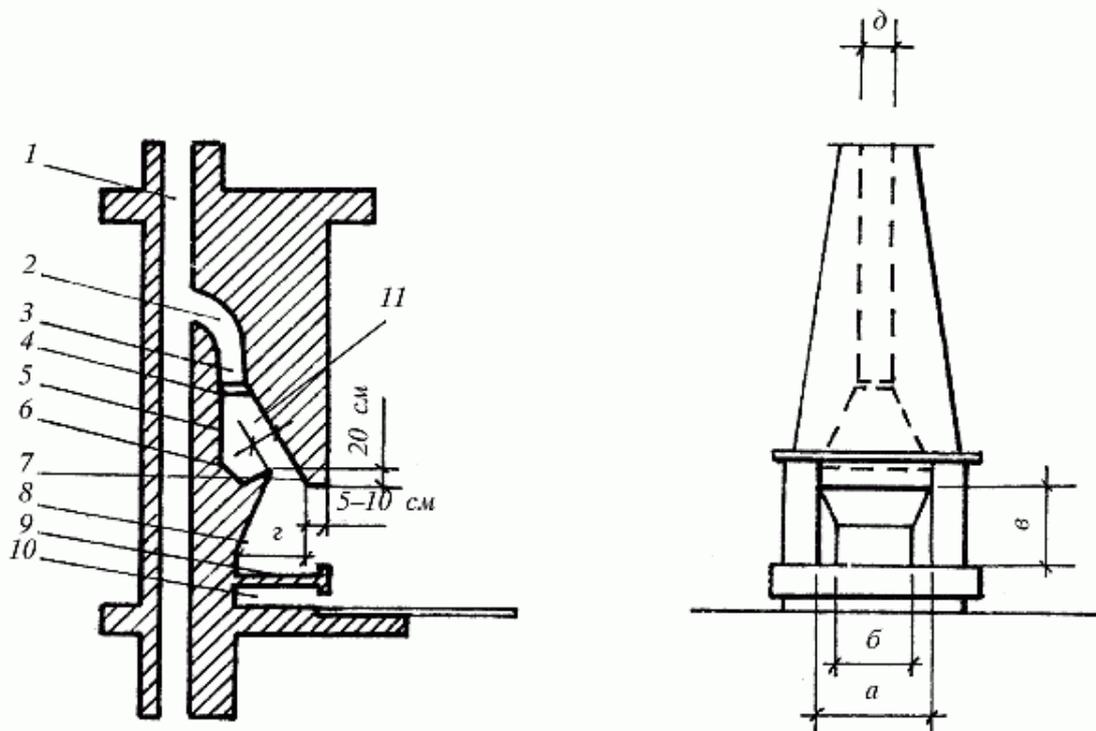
Камин, пристроенный к дымовой трубе: 1 – дымовая труба; 2 – колено; 3 – дымоход; 4 – задвижка; 5 – дымовая камера; 6 – обратное днище; 7 – стенка; 8 – топка; 9 – днище (под); 10 – зольник; 11 – дымовое отверстие (горловина); а – ширина топки; б – ширина задней стенки; в – высота топки; г – глубина топки; д – ширина дымовой трубы
